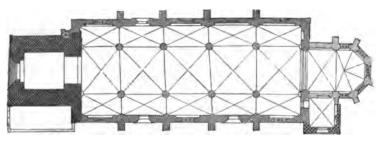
Greifswald. S. Jacobikirche. Grundriss. 1:667.
